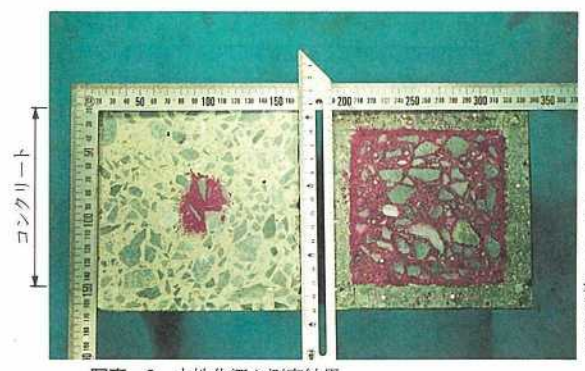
中性化深さ測定結果 (左; コンクリート, 右; 埋設型枠)
